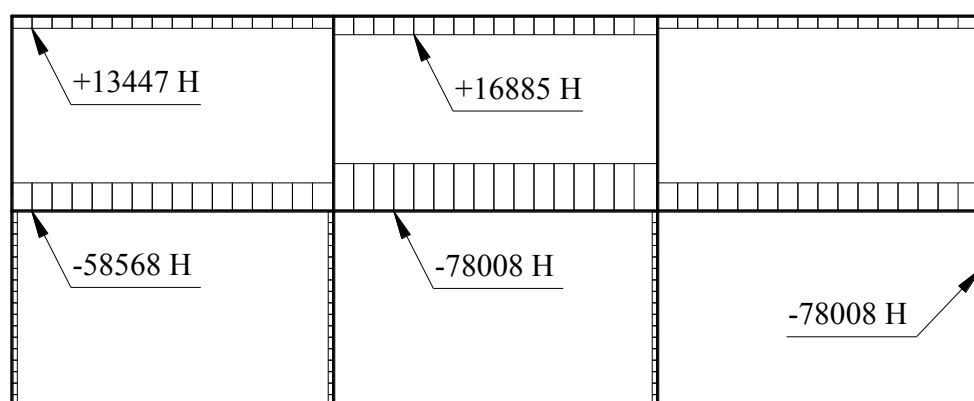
Эпюра напряжения сжатия для 1 Варианта тепловой нагрузки
